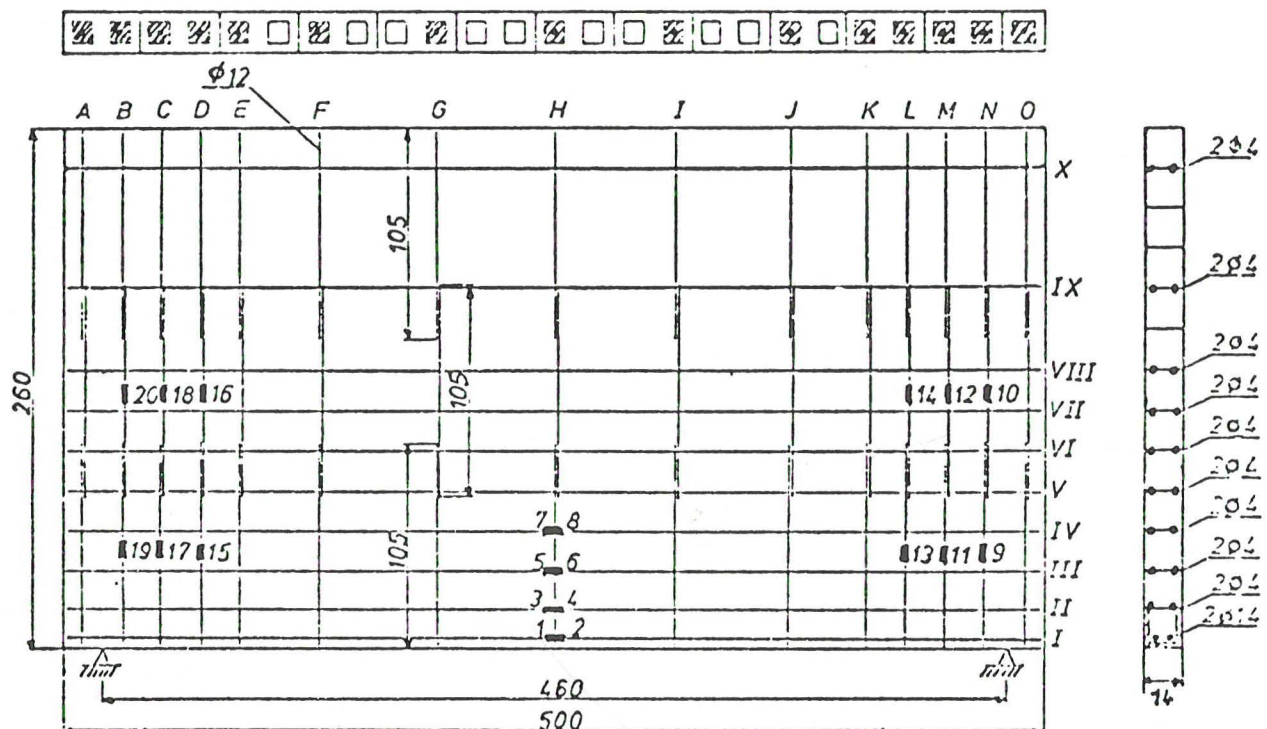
Emplacement des armatures et jauges électriques. Eprouvette n° 1; mur en blocs de béton.
